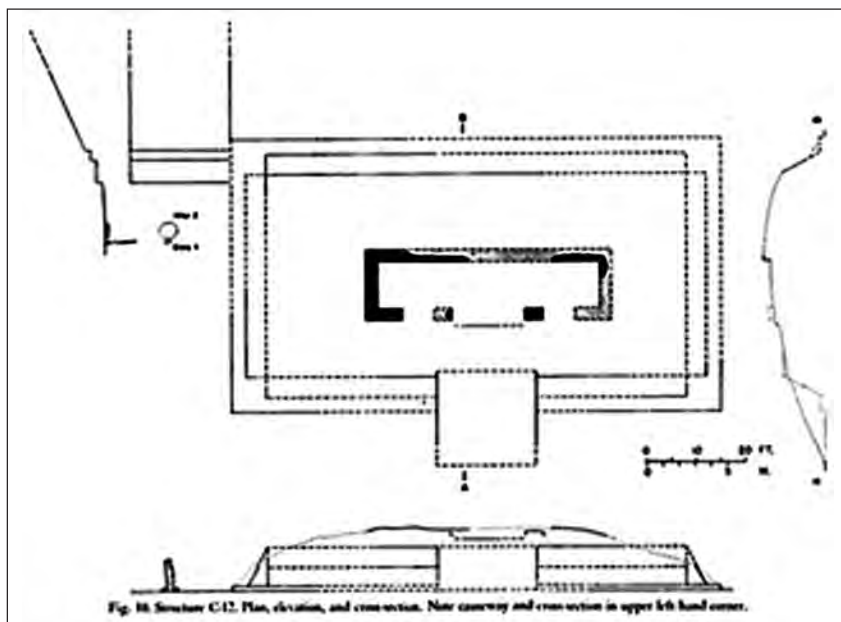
Planta y cortes de la estructura C-12 (Ferdon 1953: fig. 10).
